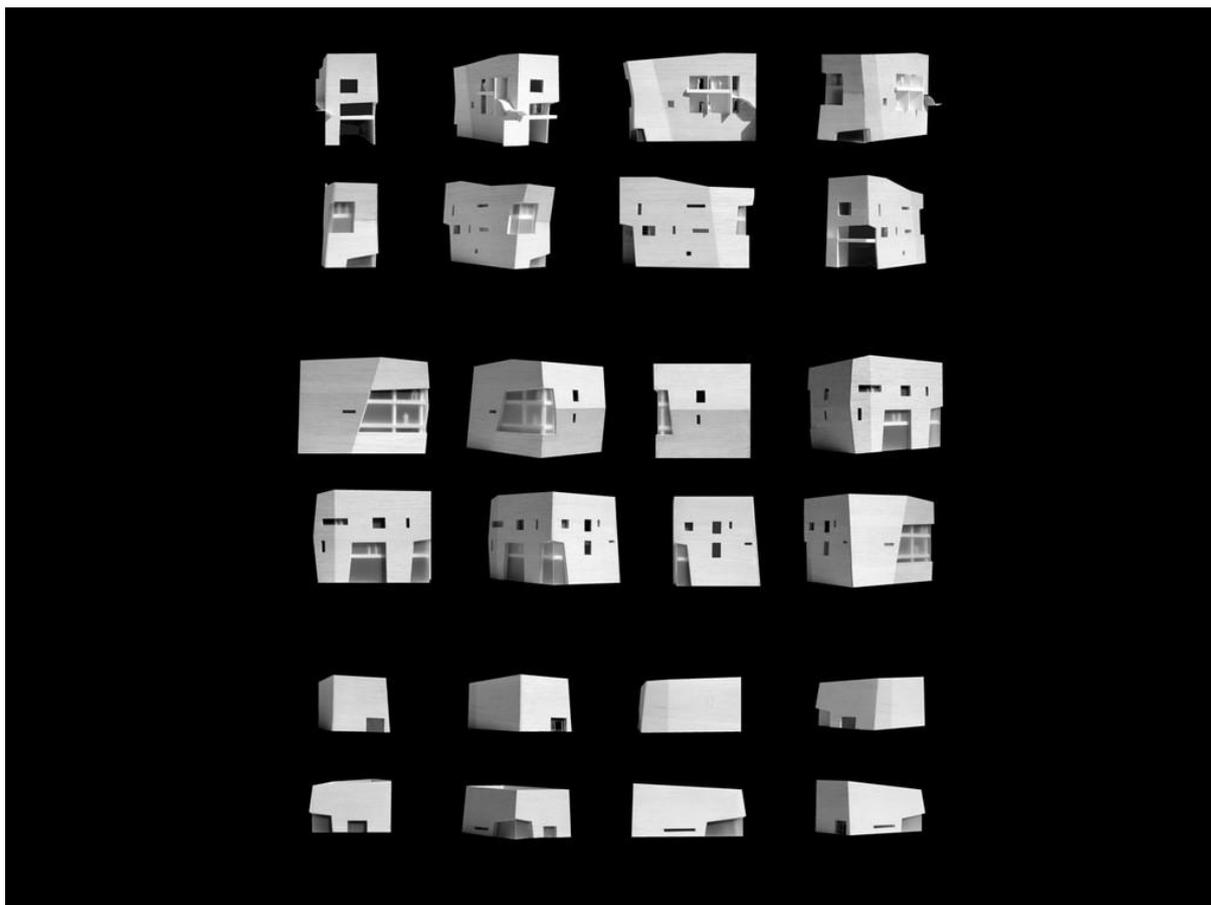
ELEVAÇÃO DAS MASSAS QUE SE ASSEMELHAM A PEDRAS
